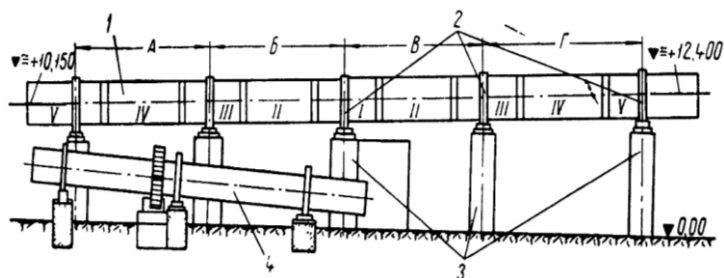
Схема монтажа секций корпуса вращающейся печи:
